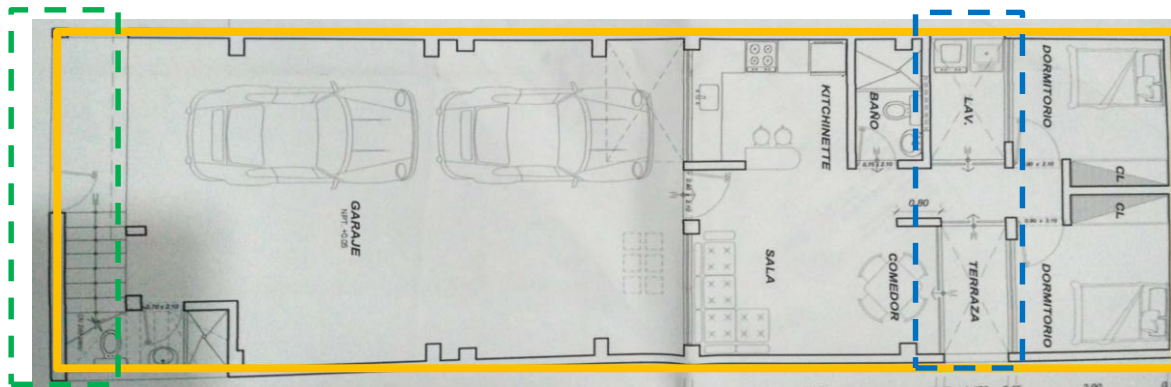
Planta del primer piso de la vivienda. Recuperado: Entrevista, 2017.
